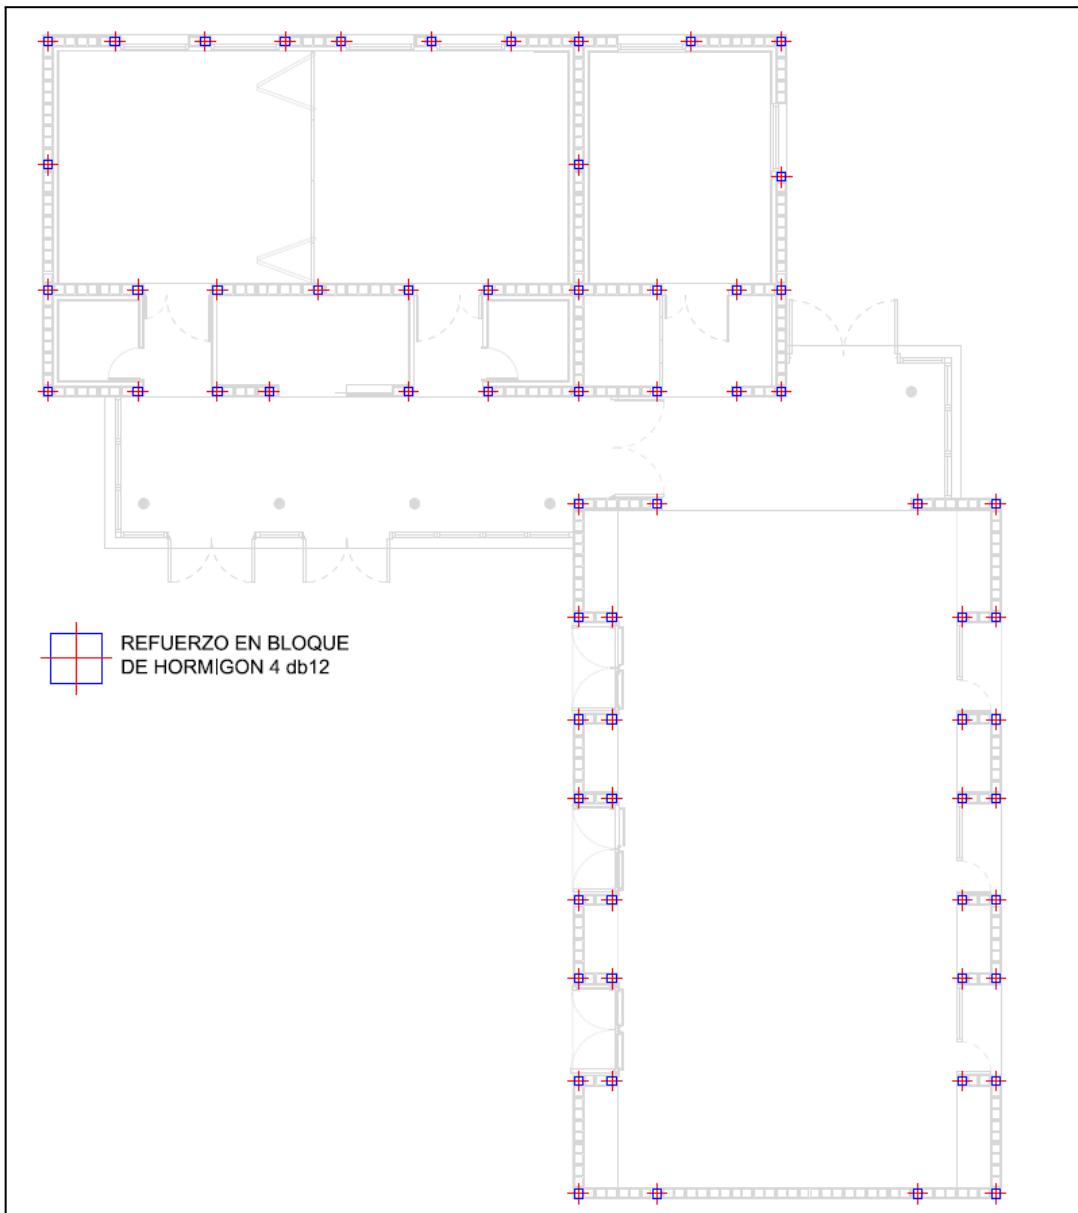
Esquema de distribución y secciones adoptadas para refuerzos de muros.
